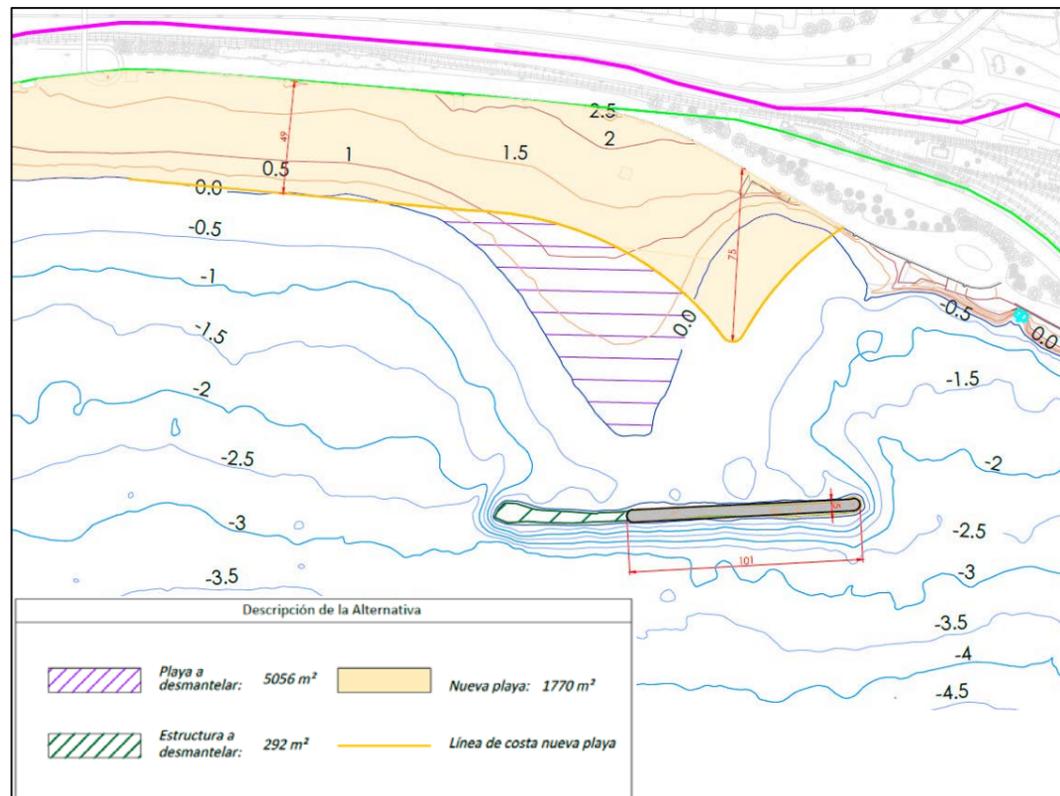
Configuración en planta de la Alternativa 1 del CEDEX.
